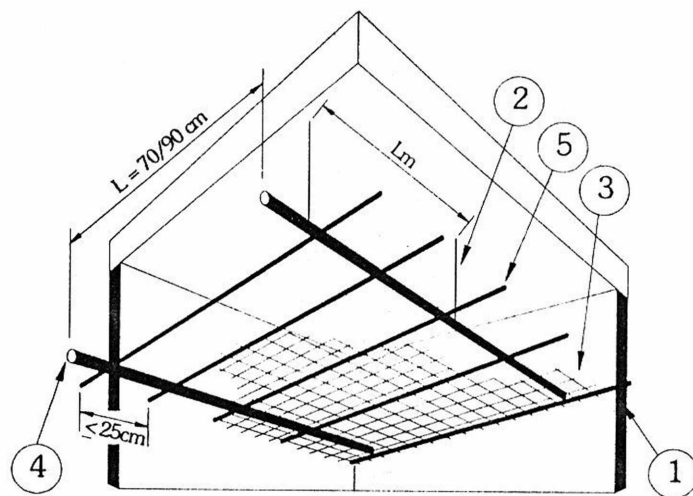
Cielo raso armado suspendido con estructura de hierro.
